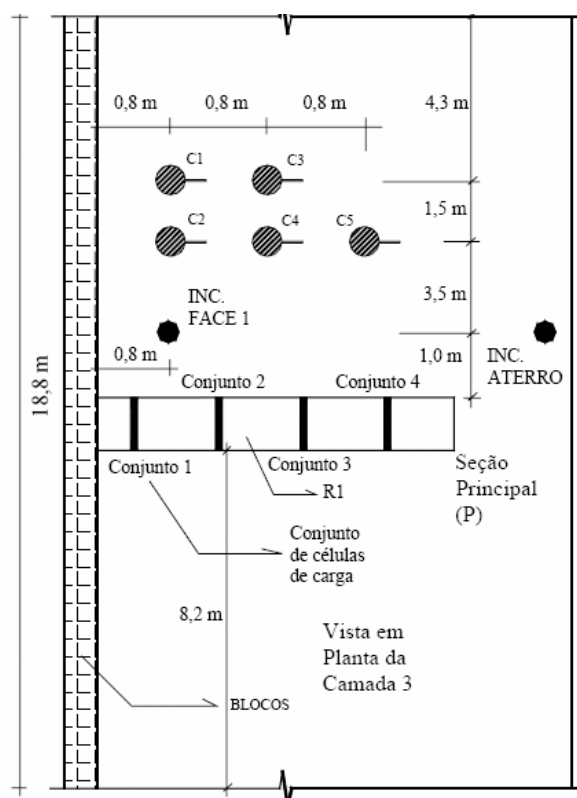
Posicionamento dos instrumentos vista em planta da camada numero 3 (Riccio e Ehrlich, 2007).
